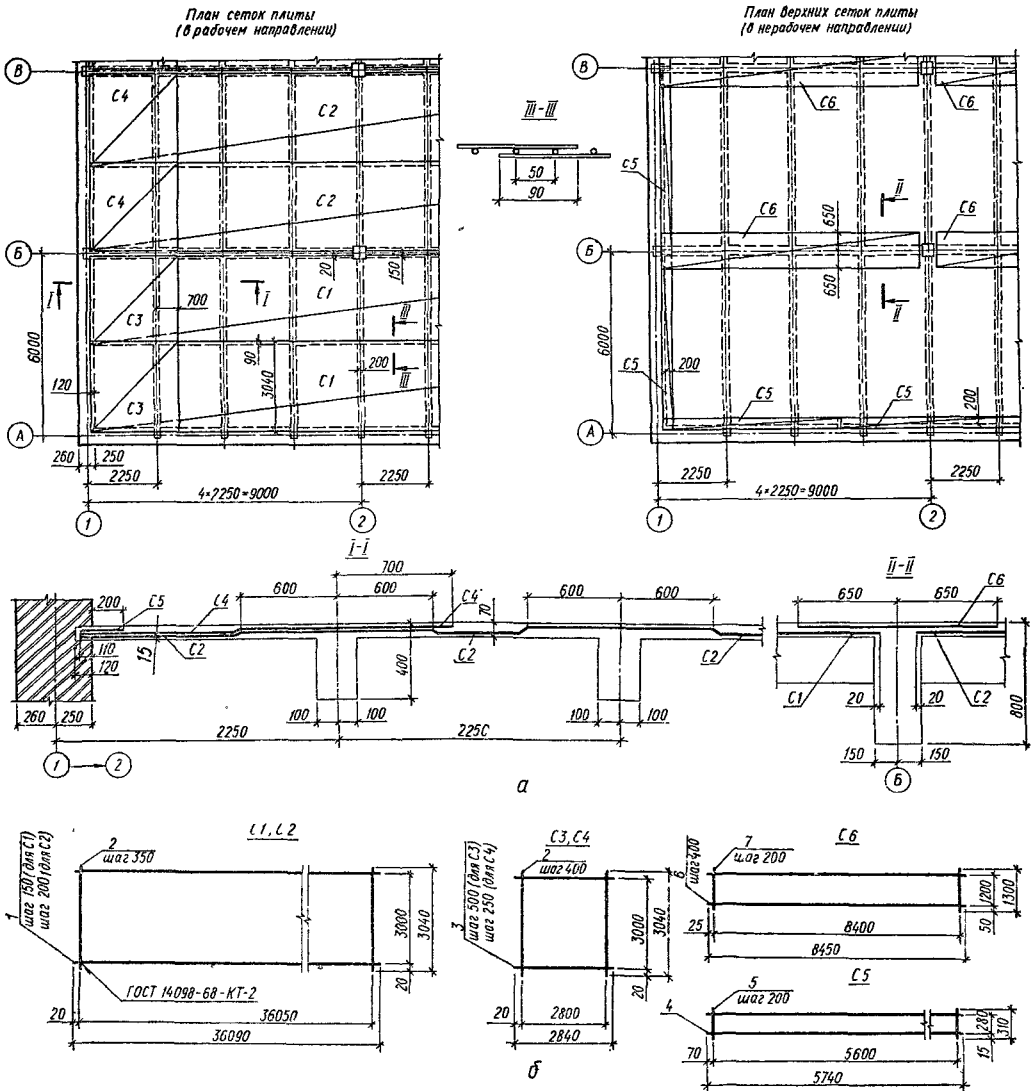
Армирование плиты ребристого перекрытия сварными рулонными сетками с продольным направлением рабочих стержней:
